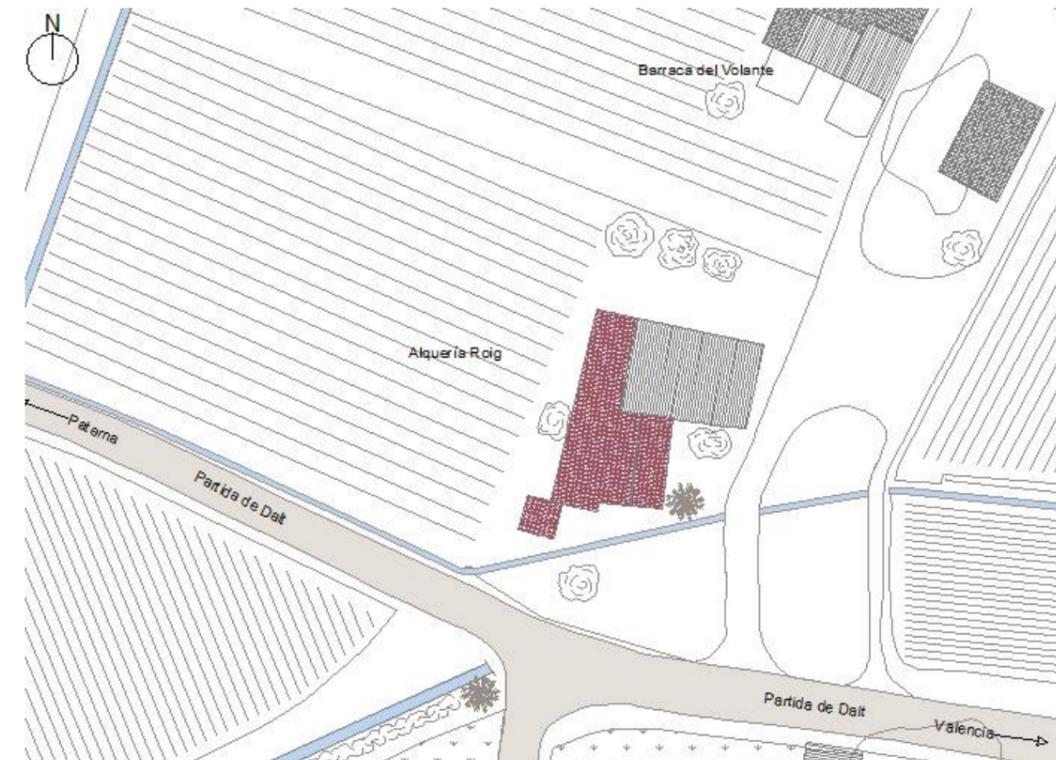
Emplazamiento Alquería Roig. Fuente: propia autora
